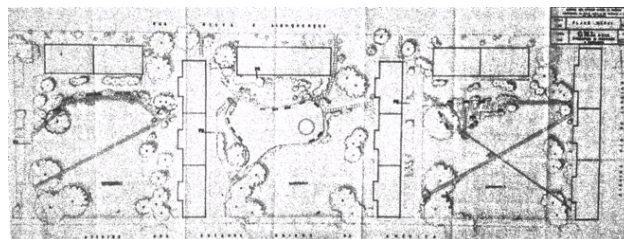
Ajardinado do troço entre a Avenida de Roma e a Avenida do Rio de Janeiro. Plano Geral, Sousa de Câmara, 1959
